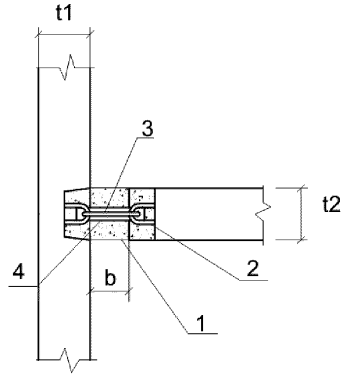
Соединение двух панелей: 1 – бетон замоноличивания; 2 – петлевые арматурные выпуски; 3 – соединительные скобы; 4 – соединительная пластина; b – 100–120 мм; t1, t2 – толщина стены (140 – 250 мм)
